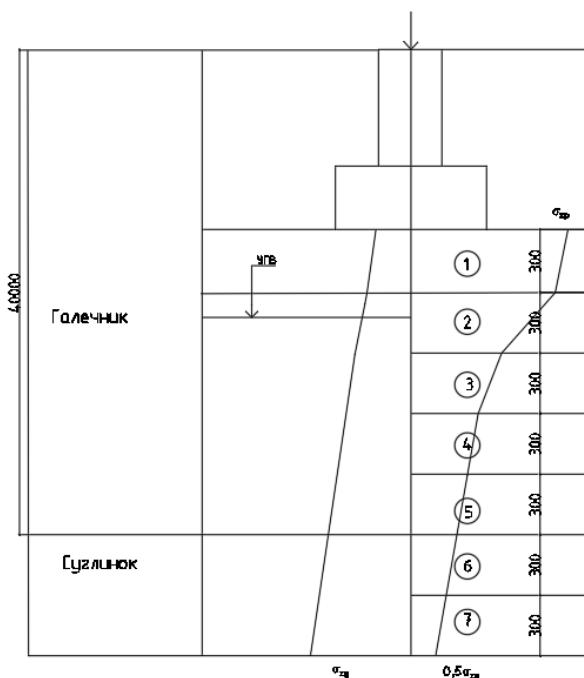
Расчетная схема к определению осадки фундамента
